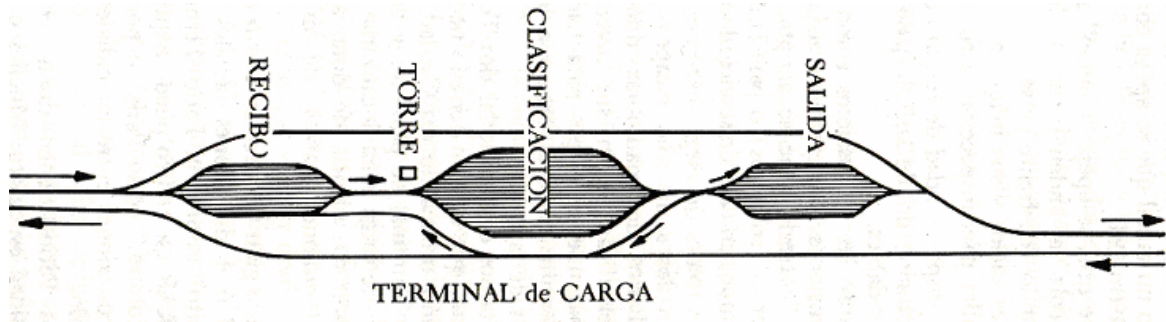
Imagen vista en planta de una Terminal de carga³²
